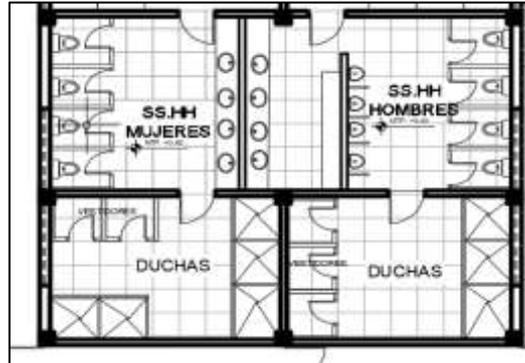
Planta primer nivel del proyecto-Servicios Generales.
